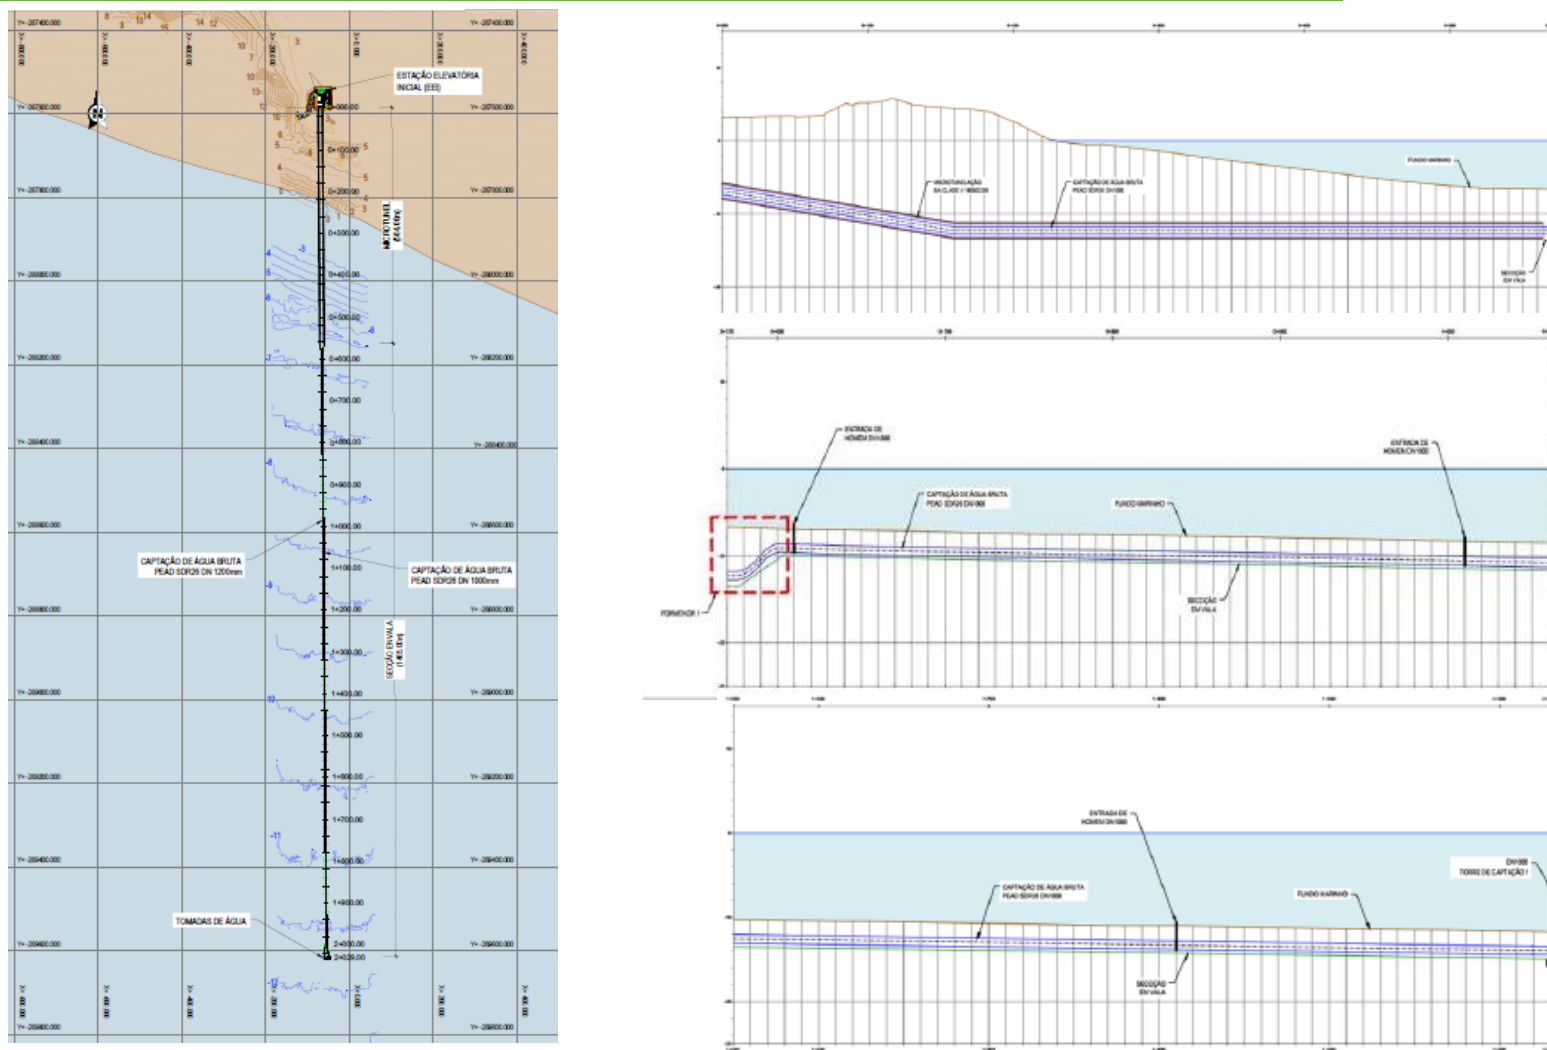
Condução de captação de água bruta *offshore* – planta e perfil longitudinal
